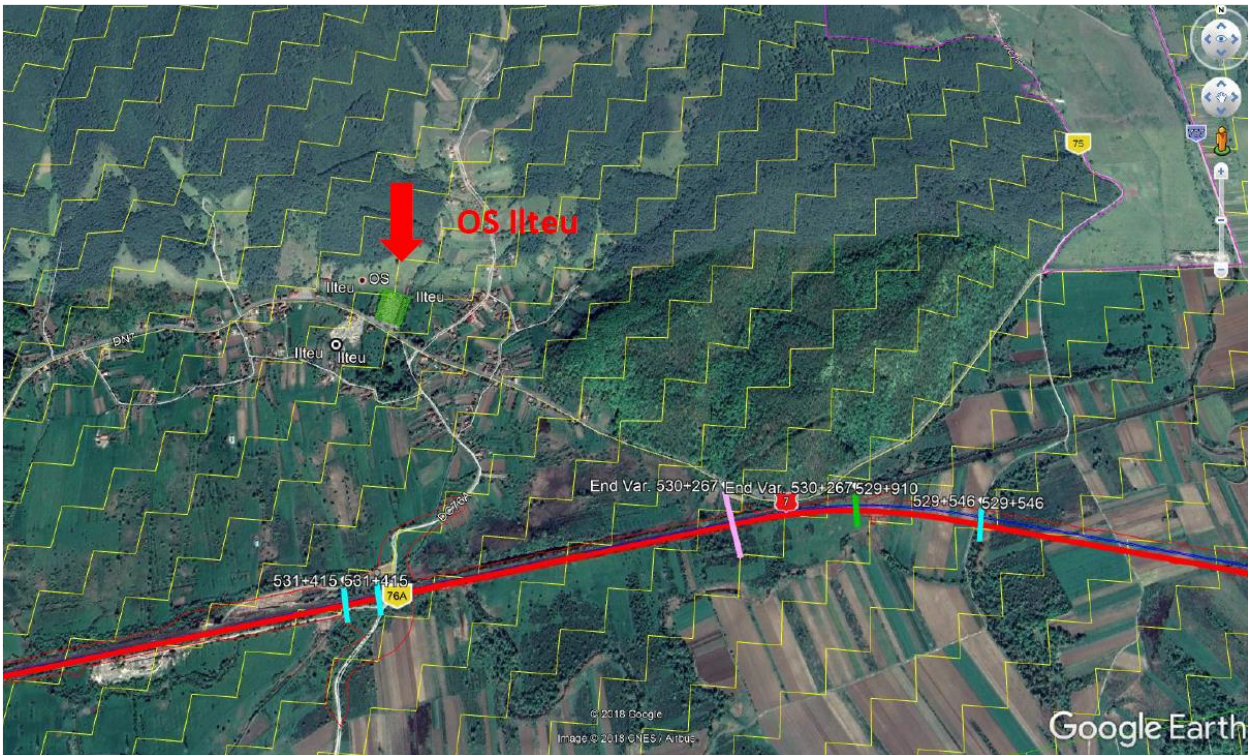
Plan de amplasament pentru organizarea de șantier OS Ilteu – vedere din satelit
